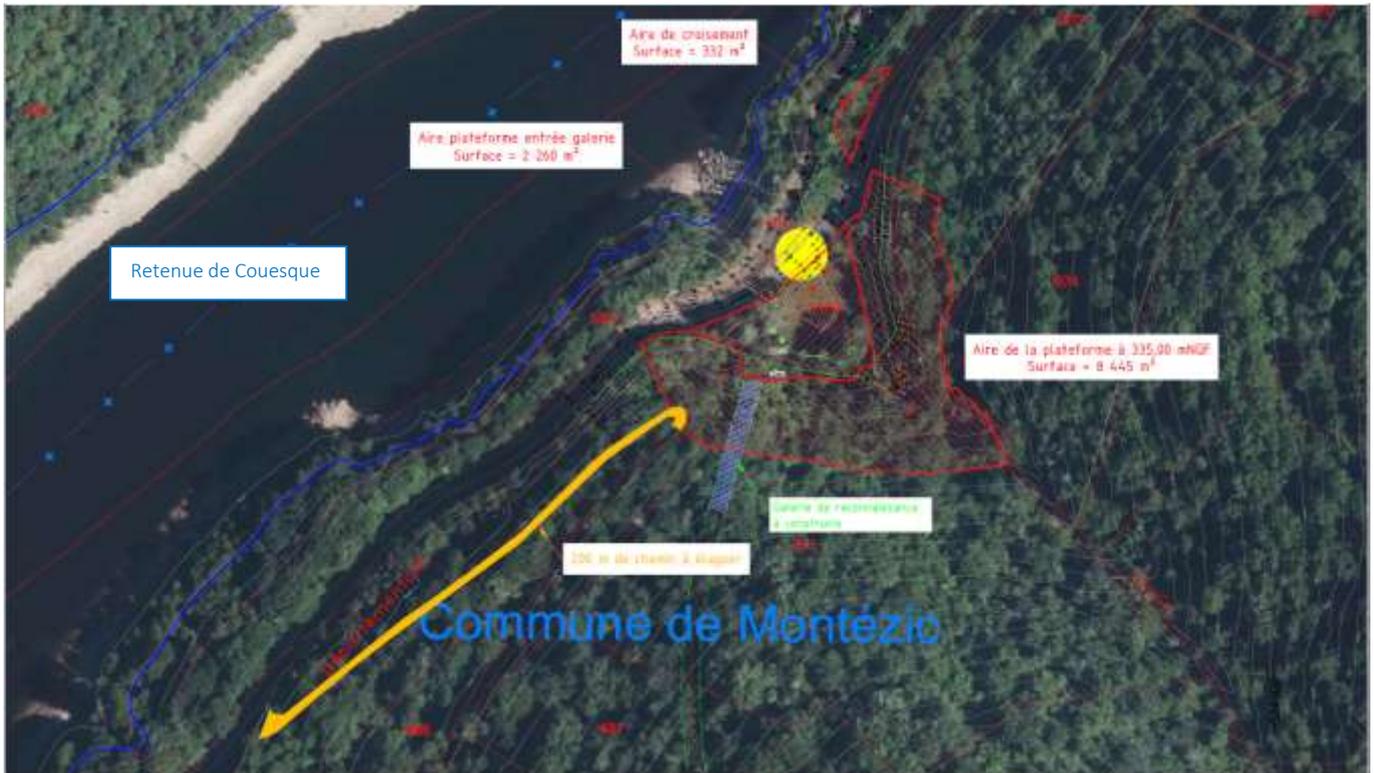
Emprises des zones de sécurisation et d'installation de chantier au niveau de la zone entrée galerie (vue en plan) - source : EDF
